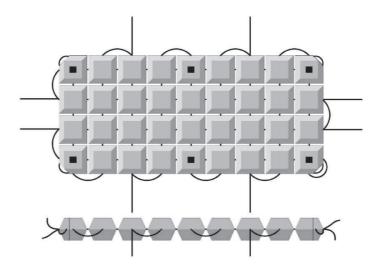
Покрытие бетонное защитное гибкое универсальное –105
